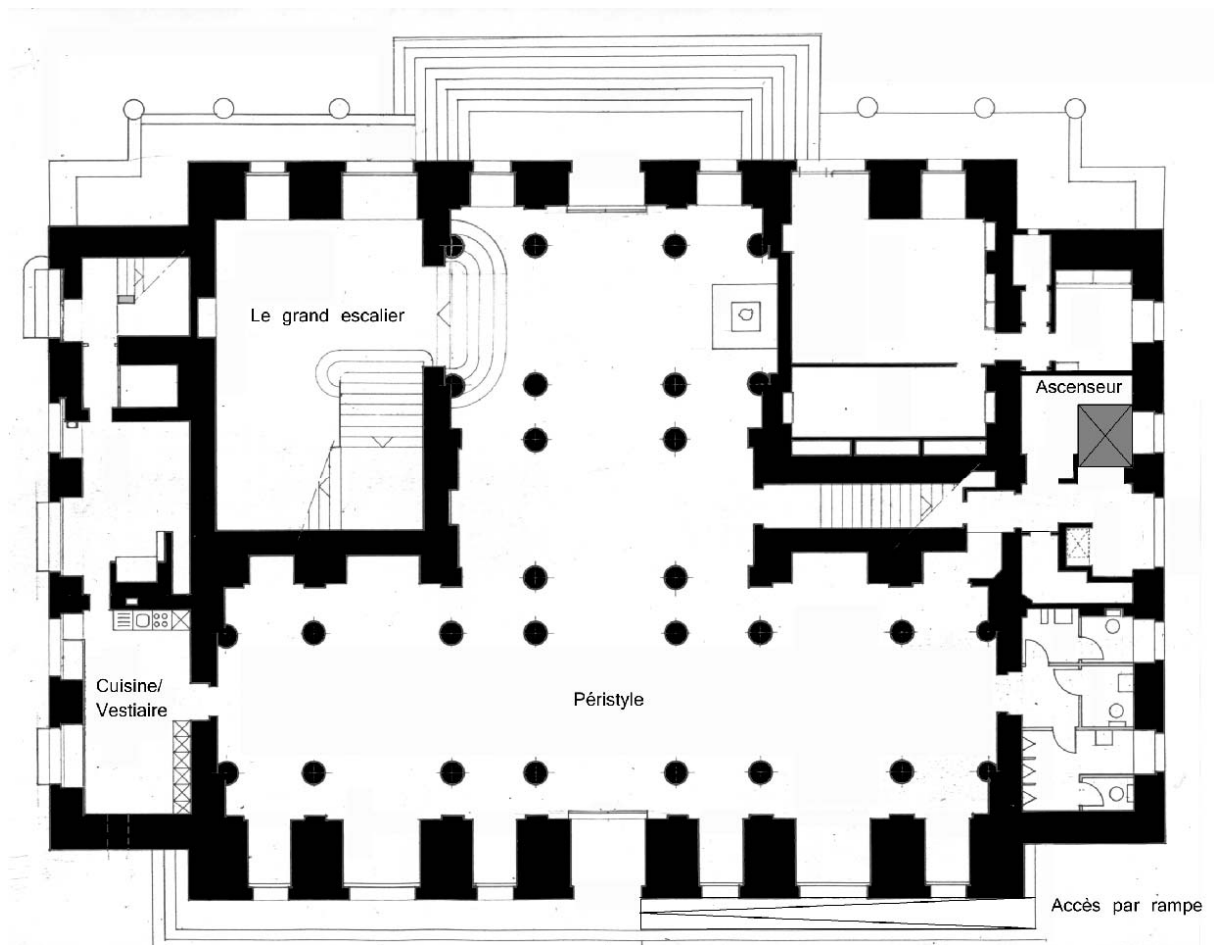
Plan du rez-de-chaussée (projet avec ascenseur et rampe)
